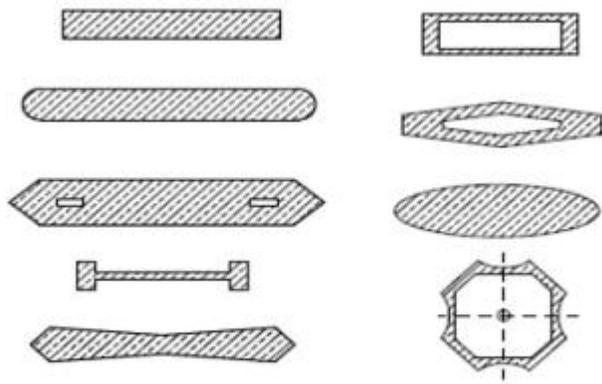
Formas de secciones transversales de pilares-pared
